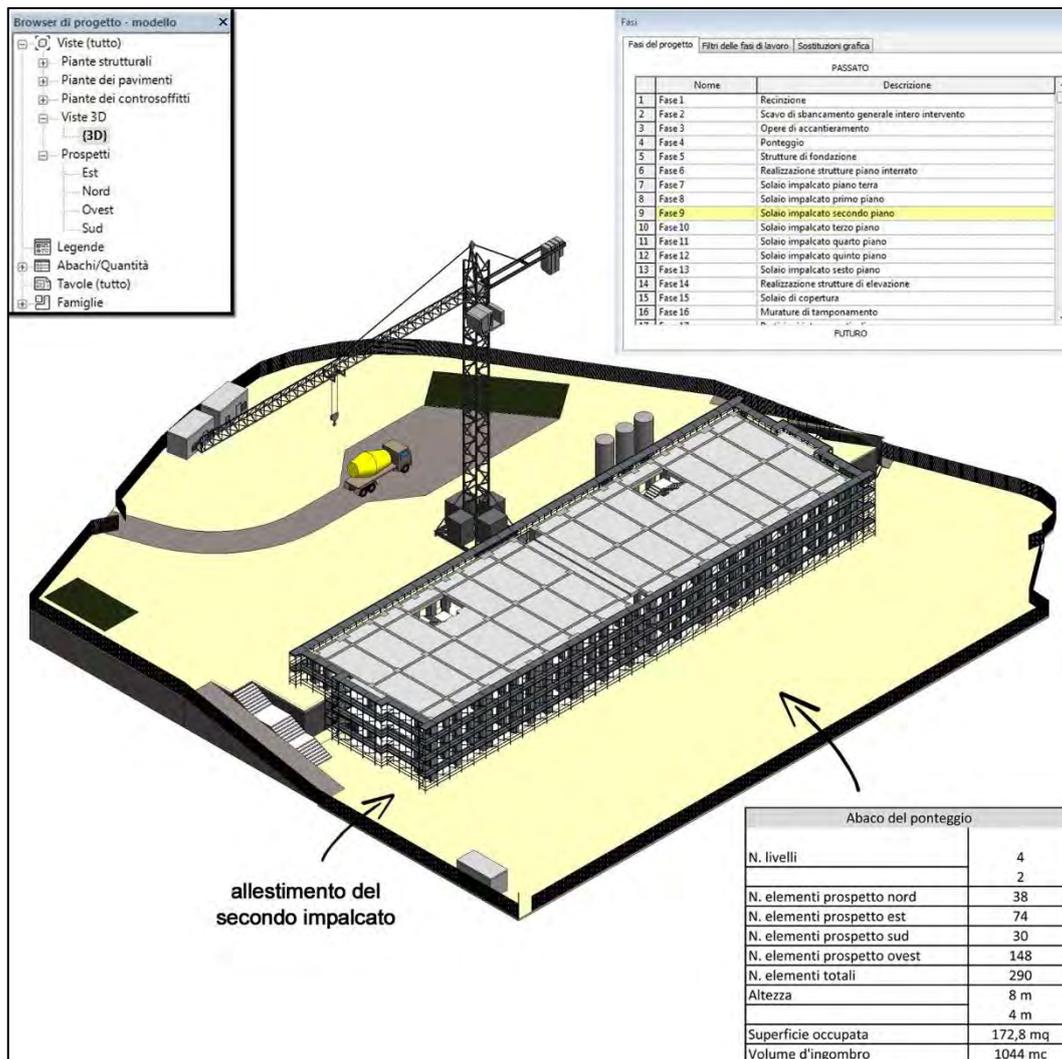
Assonometria della fase di allestimento del secondo impalcato
